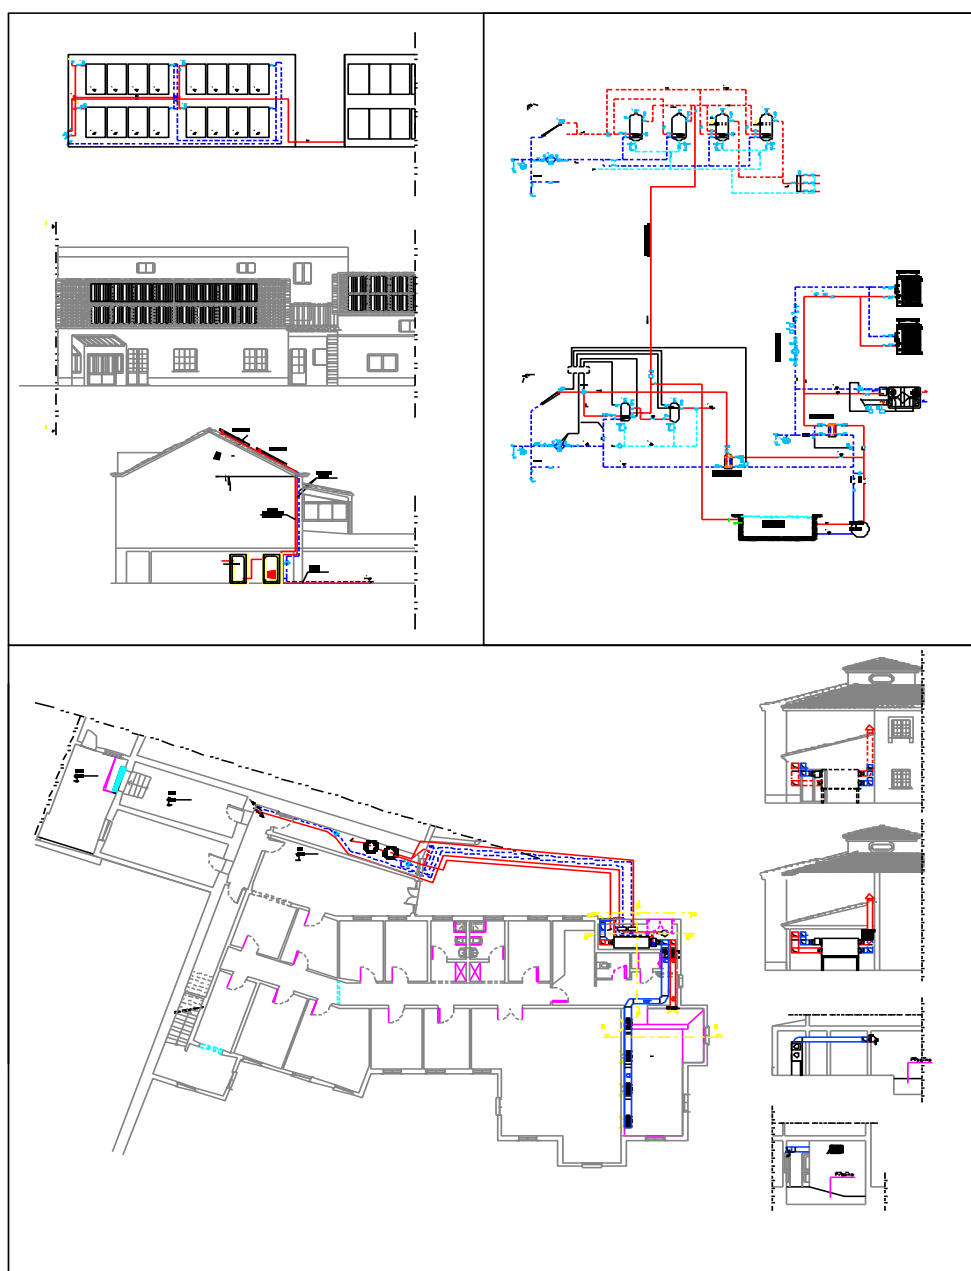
Esquemas e traçado de tubagem da instalação de AQS e de ventilação da piscina
